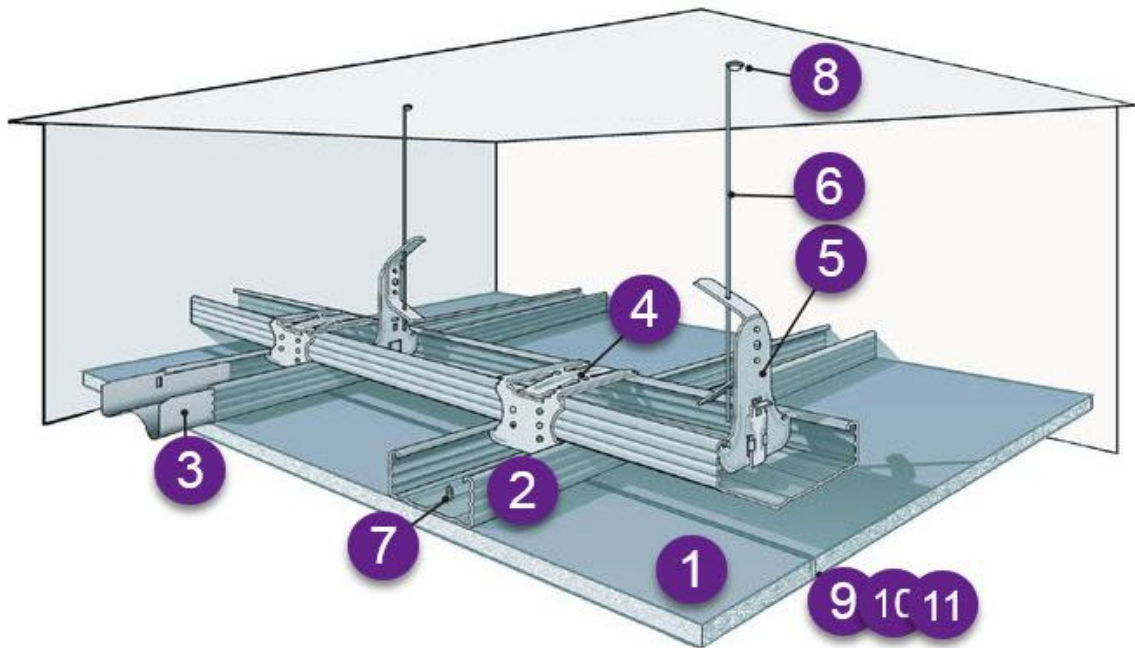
Підвісні стелі з металевим каркасом: 1 – лист ГКЛ; 2 – профіль металевий; 3 – профільний з'єднувач; 4 – з'єднувач профілів другого рівня; 5 – затискний підвіс; 6 – тяга підвісна; 7 – саморіз метал-метал; 8 – анкер кріпильний; 9 – малярська стрічка; 10 – шпаклівка по гіпсокартону; 11 – ґрунтовка
